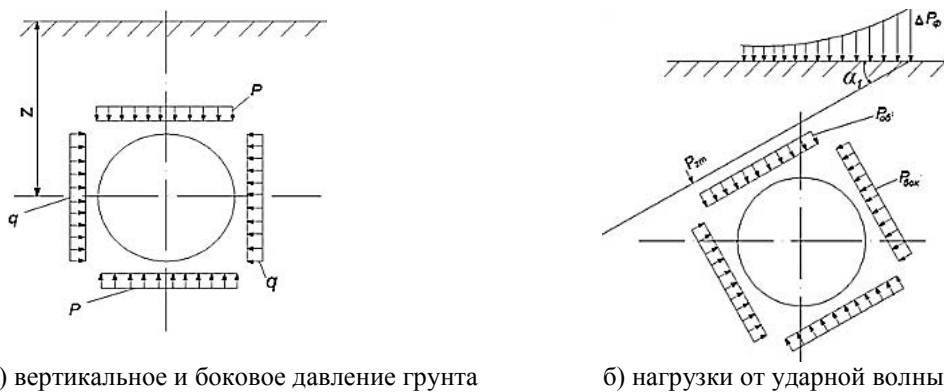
Схема нагрузок и конструкция оболочки к расчету на равномерно распределенную нагрузку
